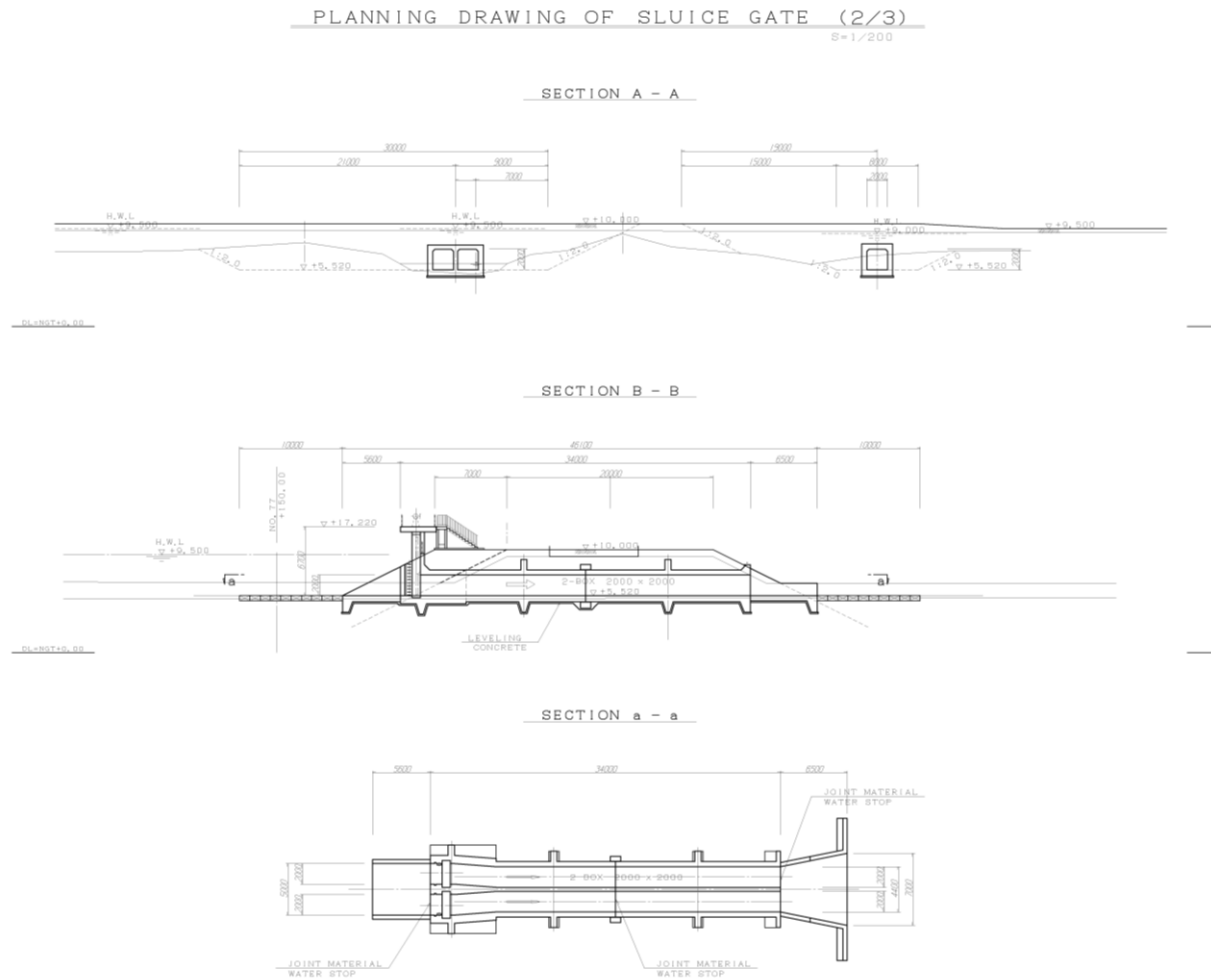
流量調節施設一般図(2) 放水路ゲート
